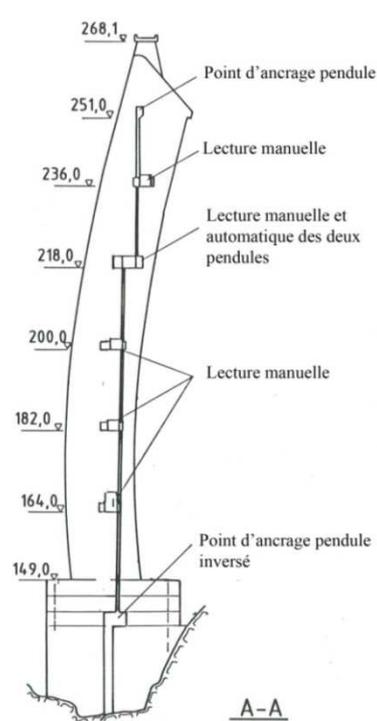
Barrage d'Alta : schéma d'implantation des pendules (coupe A-A)
